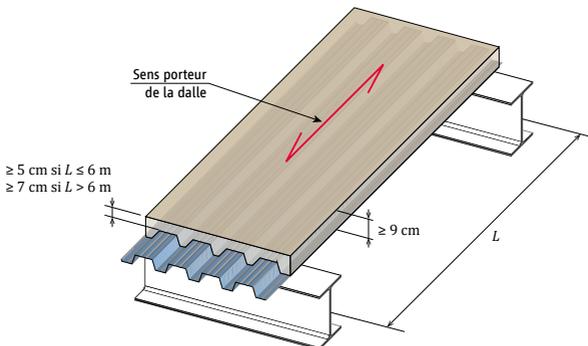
Dimensions minimales d'une dalle mixte pour l'effet diaphragme
